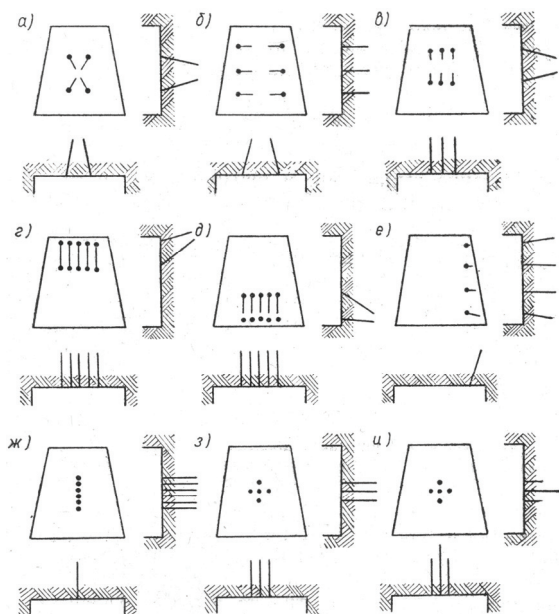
Схемы конструкции врубов, применяемых для проходки горизонтальных выработок подземных хранилищ [11]:
